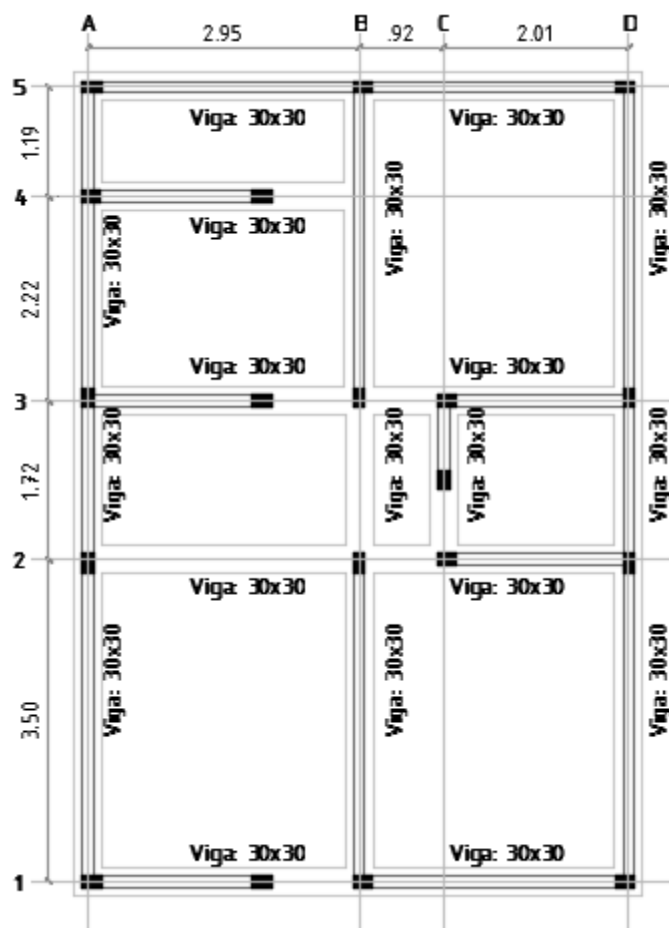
Replanteo estructural de ubicación de muros de mampostería confinada
